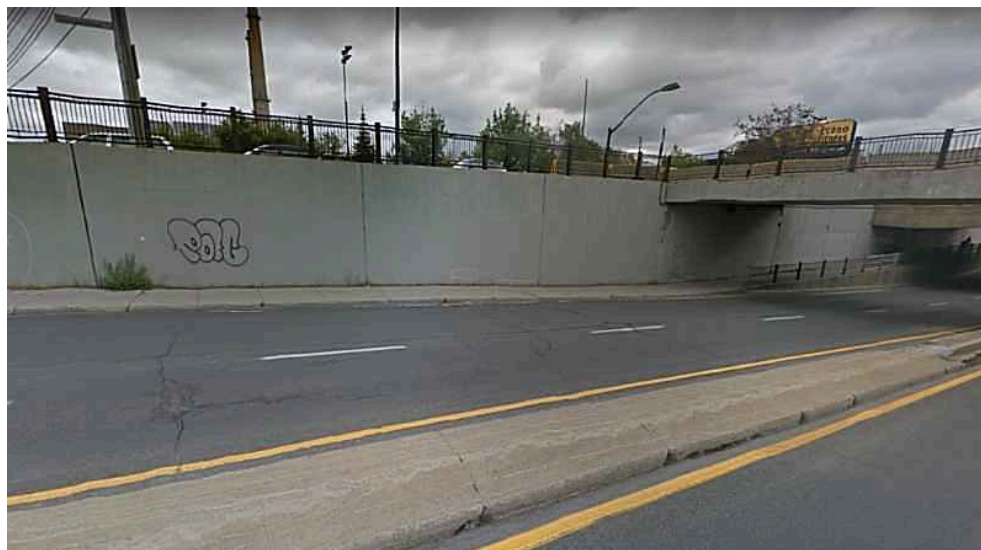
Mur de soutènement type (M.S. 81-05169C)
